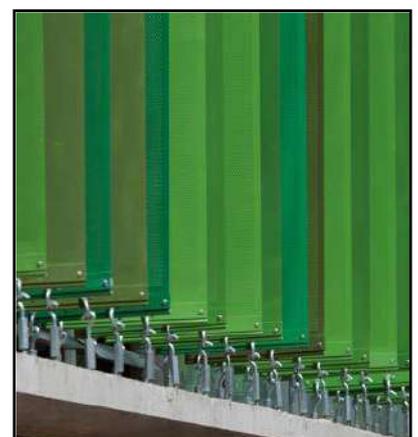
Protección Solar. FUENTE: Elaboración Propia
